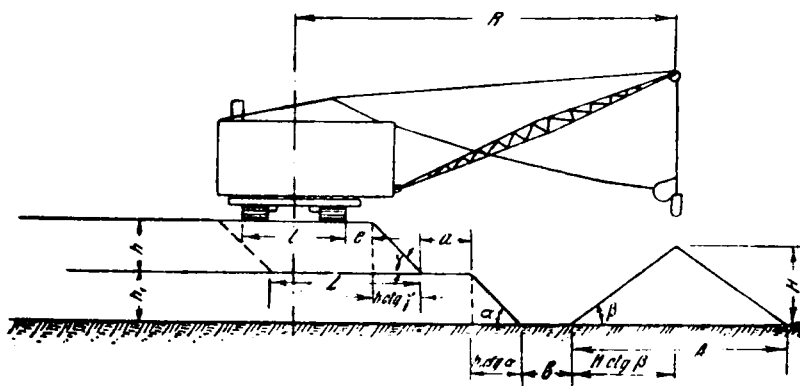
Схема разработки вскрыши драглейном с укладкой грунта в выработанный забой
